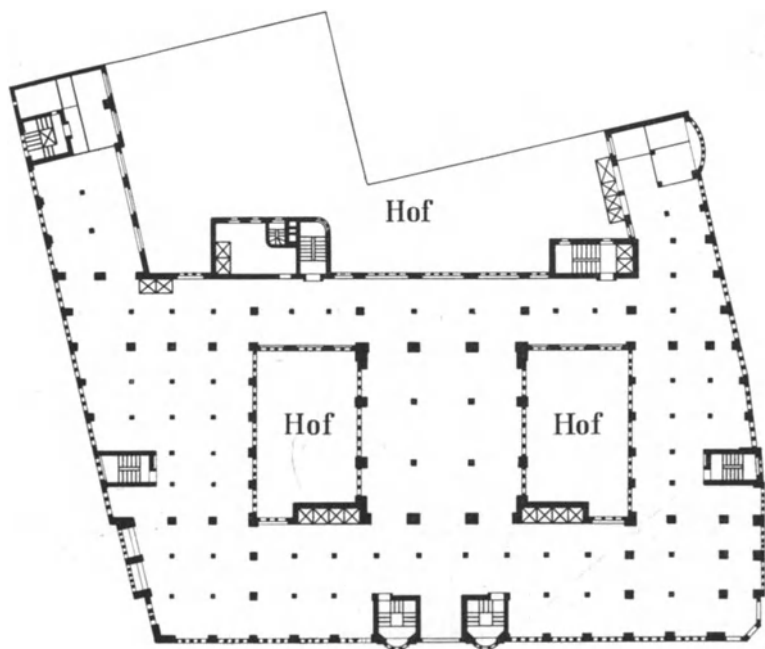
Grundriß eines Warenhauses, bei welchem zur Aufnahme von Leitungen geeignete Wandflächen völlig fehlen.
